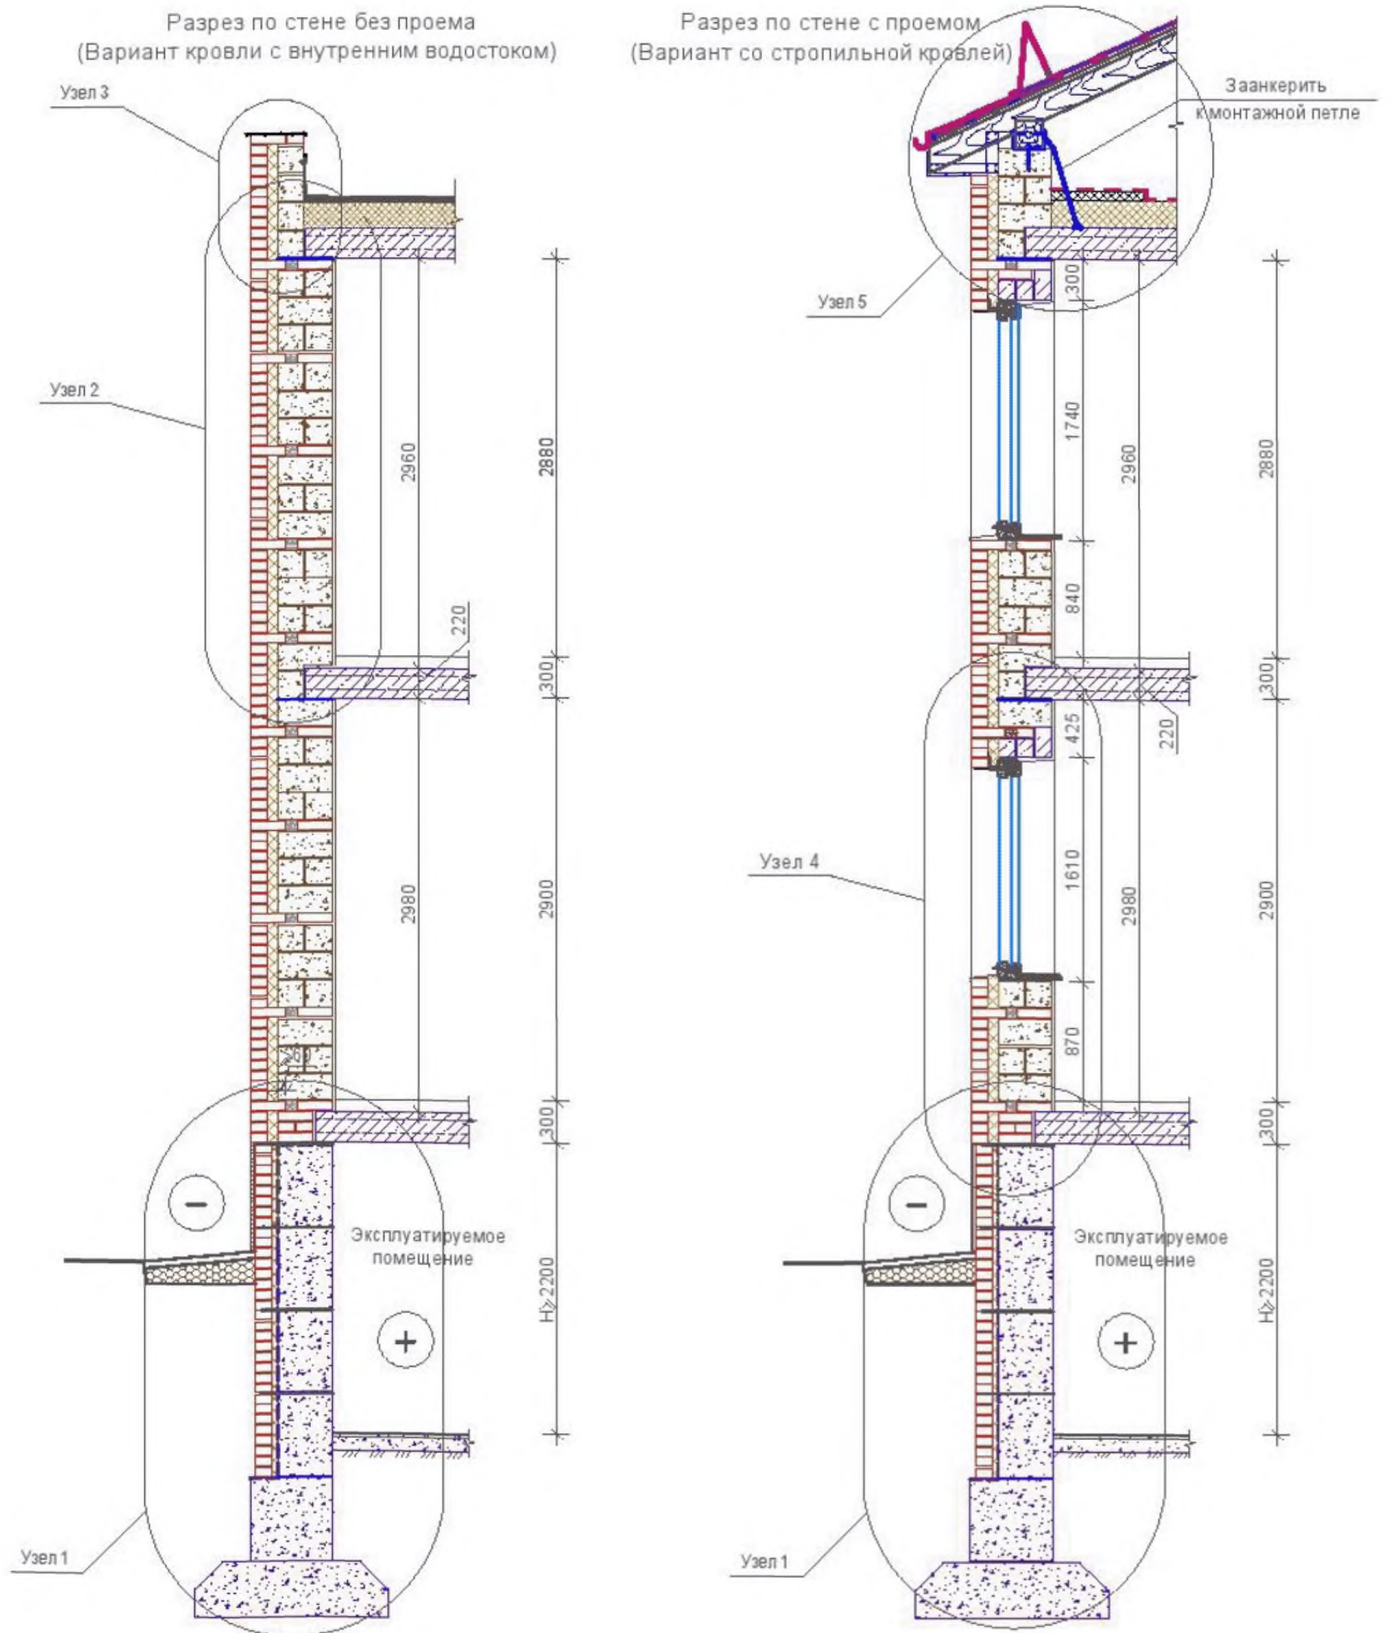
Схема нумерации узлов на поперечном разрезе здания (Стены со связью облицовочного слоя с основным тычковыми рядами)
